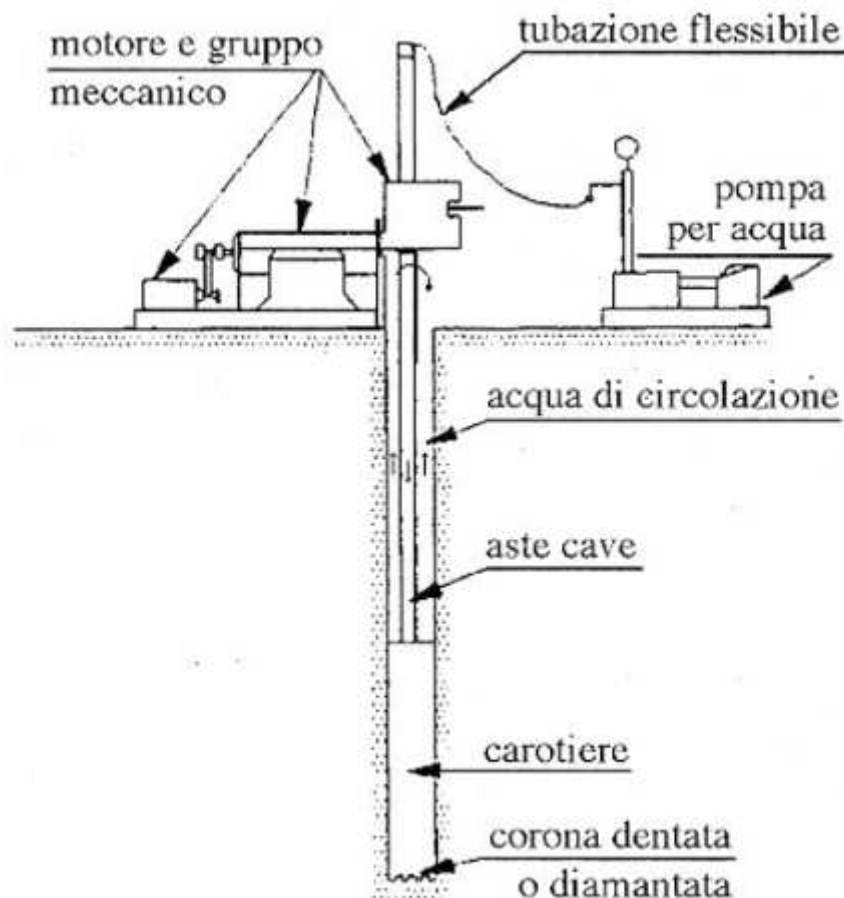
Schema di cantiere per sondaggi a rotazione e carotaggio continuo.
